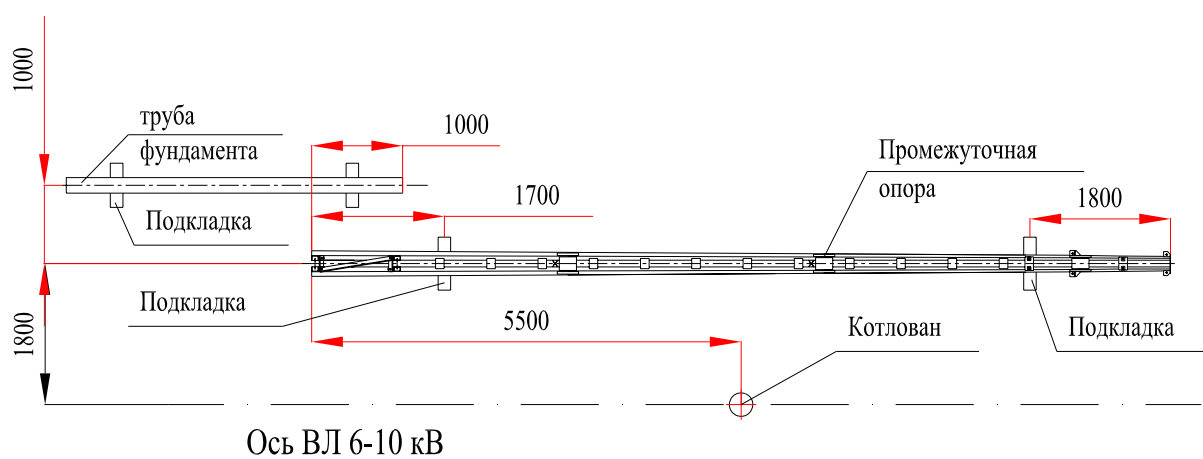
Схема выкладки металлических стоек опор и труб фундаментов при выгрузке
